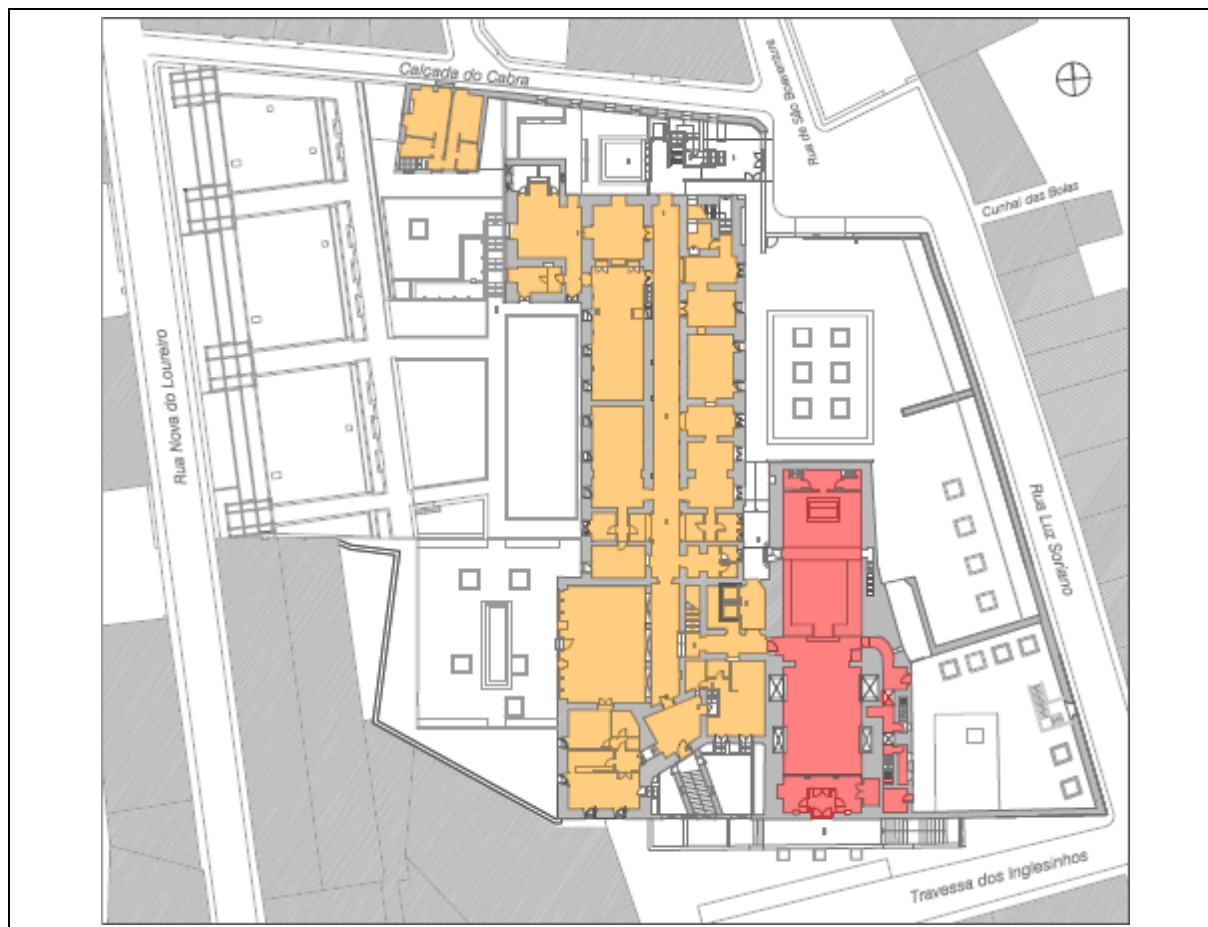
Planta de implantação do edifício do Colégio [99]
